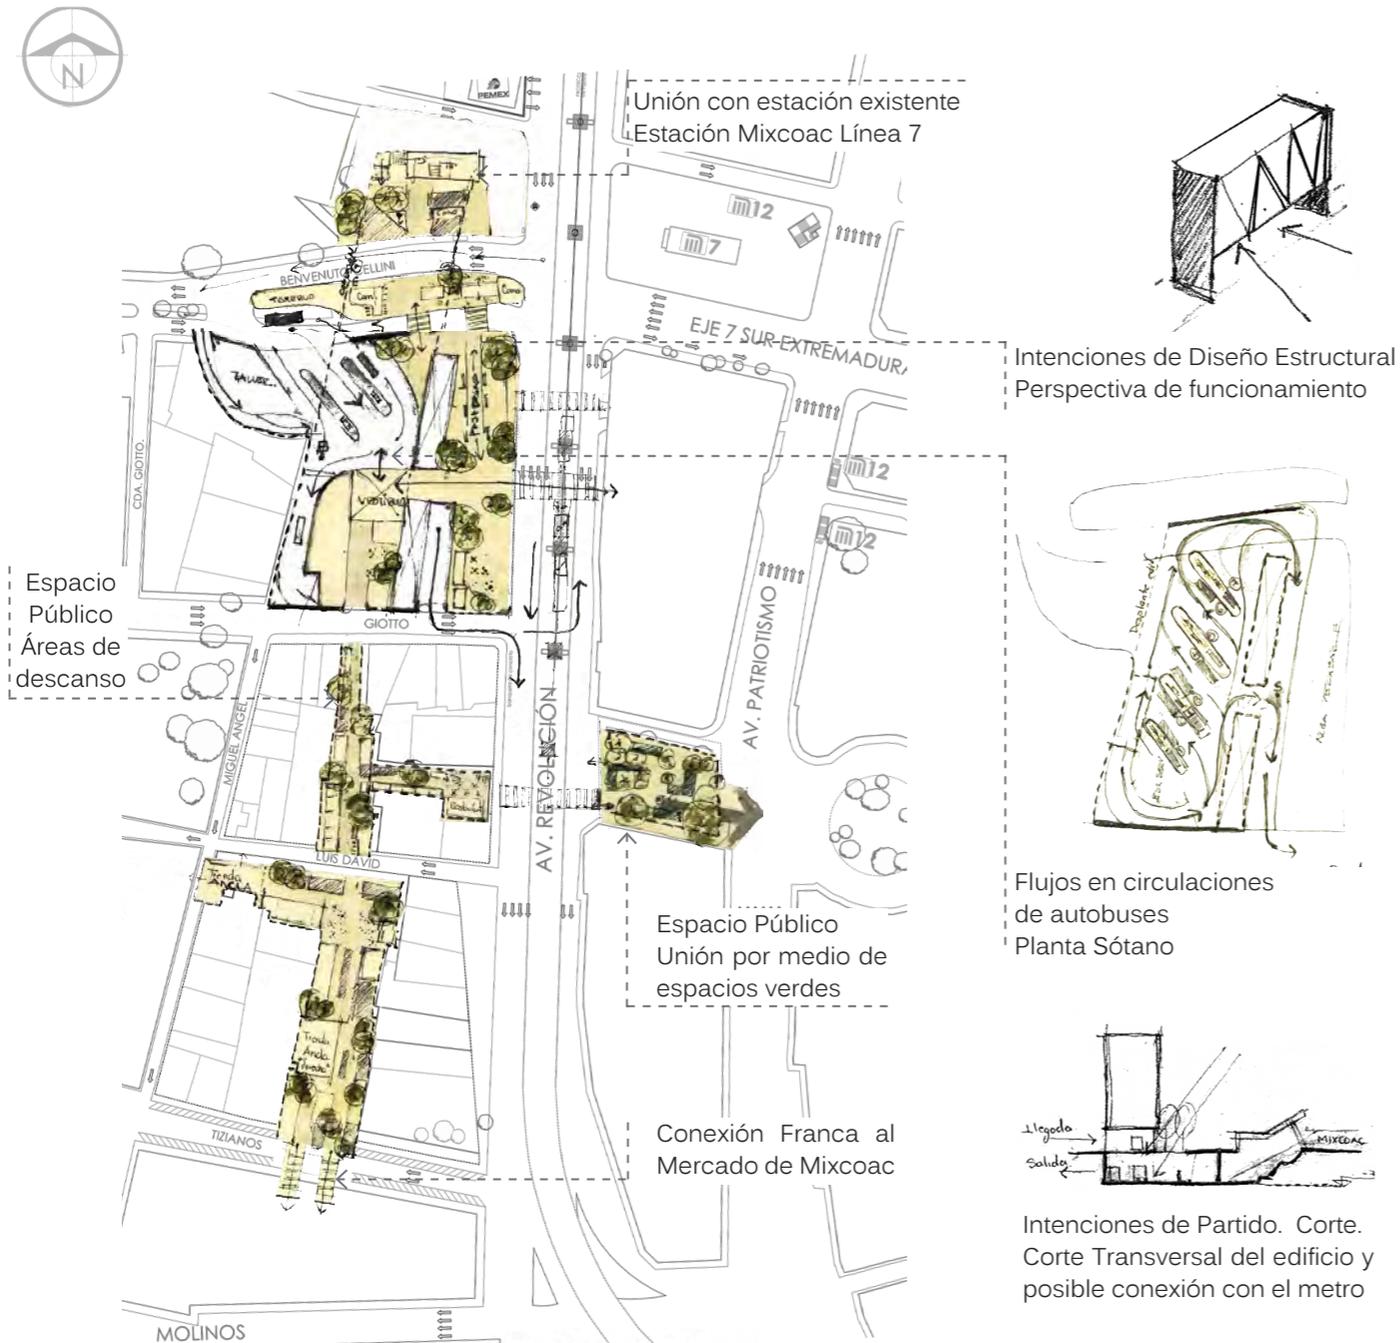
Plano con intenciones de plan maestro. Fuente: Elaboración Propia
